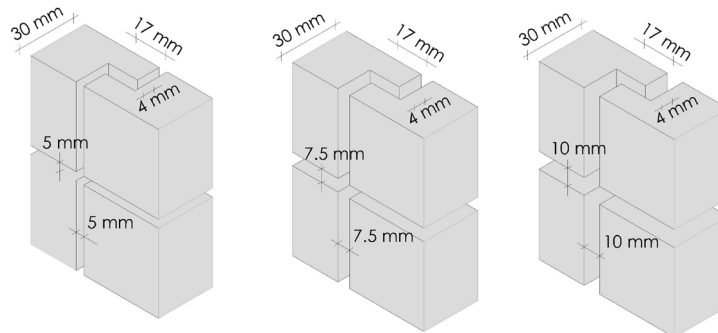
Esquema de junta vertical rebajada y horizontal lisa para las amplitudes de 5, 7.5, 10 mm.
